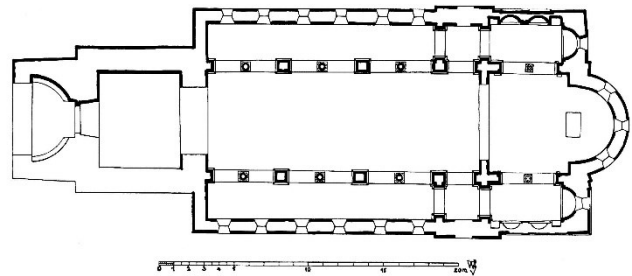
Grundriss von St. Lucius in Werden/Ruhr
